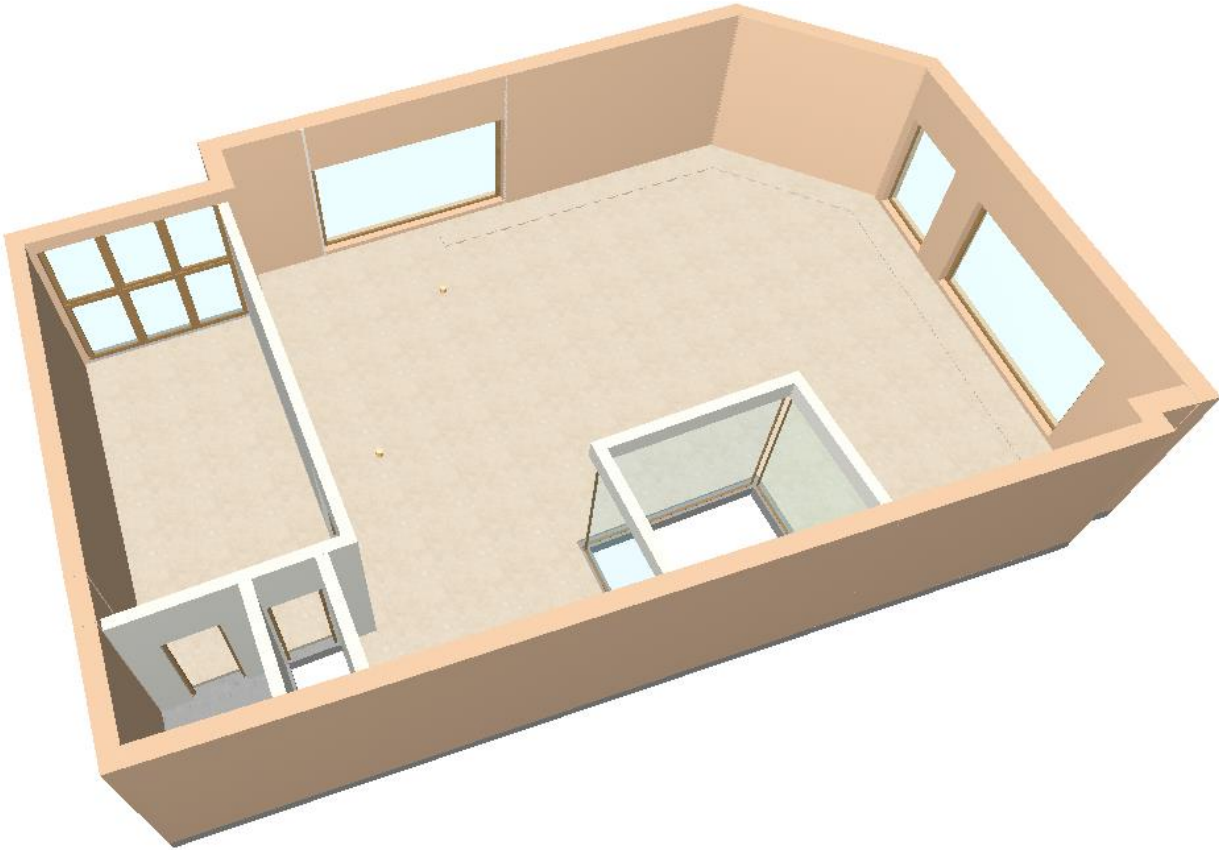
Simulación de la segunda planta en la que se aprecia el vacío bajo el lucernario, y el hueco en el forjado existente entre las plantas primera y segunda.
